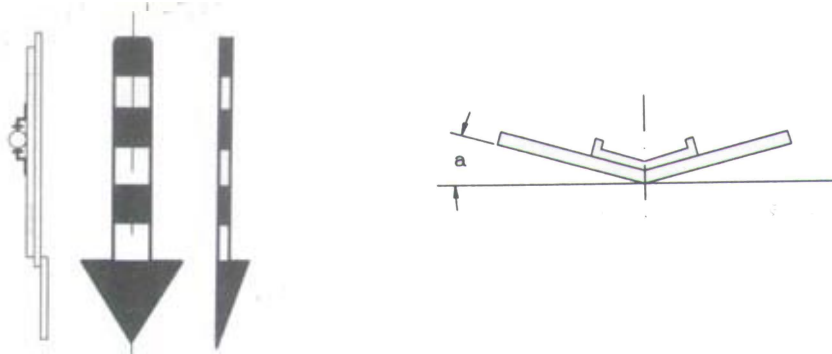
structure tridimensionnelle du panneau      Figure 2 section du panneau
